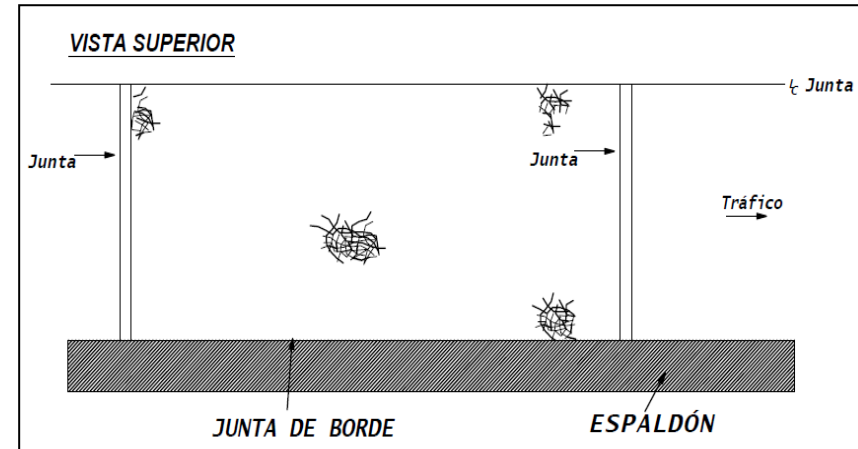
Esquema Grieta de Malla- Pavimento Rígido
